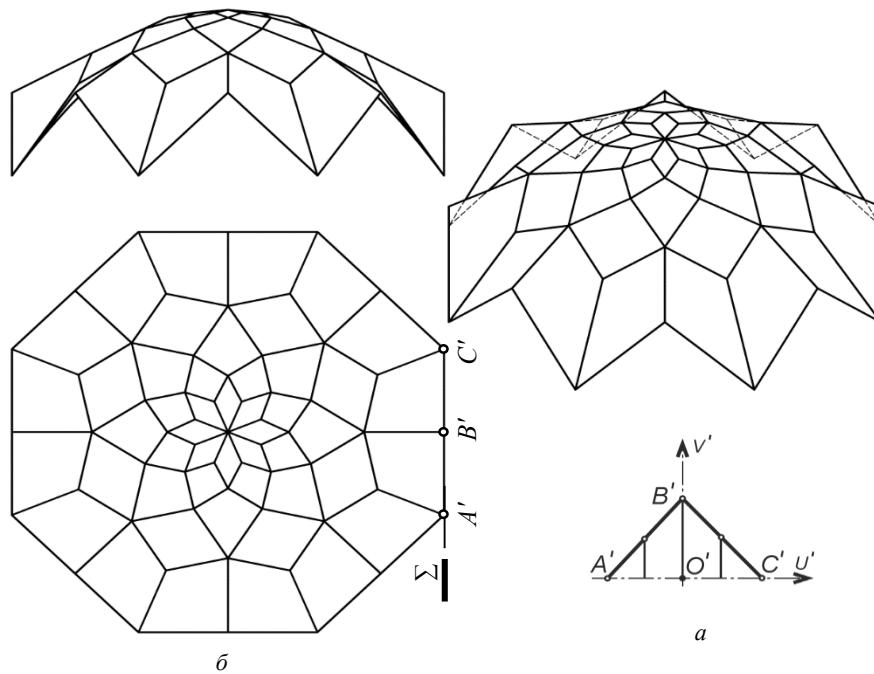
Варіювання форми ДПП за рахунок зміни форми опорного контуру
